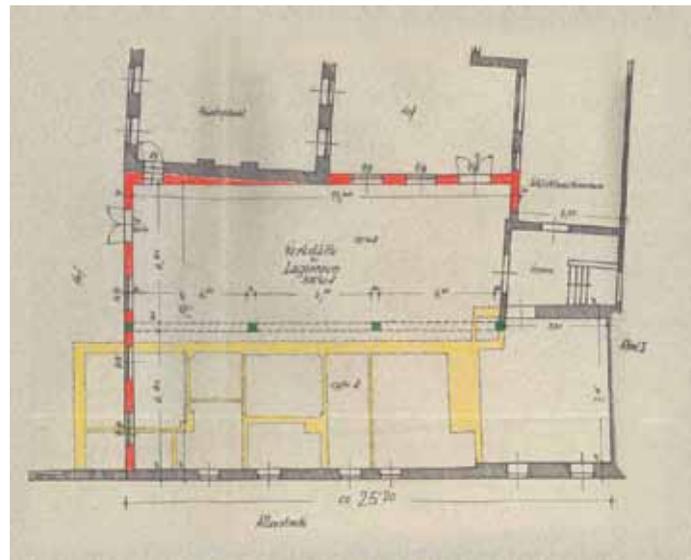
Erdgeschoß-Grundriss zum Zubau des Websaales, 1961; Die Hausmeisterwohnung ist als Abbruch der Schlichtmaschinenraum als Bestand dargestellt
